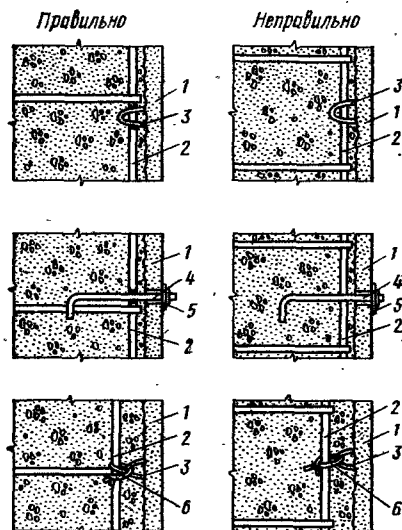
Узлы крепления опалубочных плит к армокаркасу: 1 — плита; 2 — армокаркас; 3 — анкерующая петля; 4 — стяжка; 5 — шайба; 6 — скрутка
